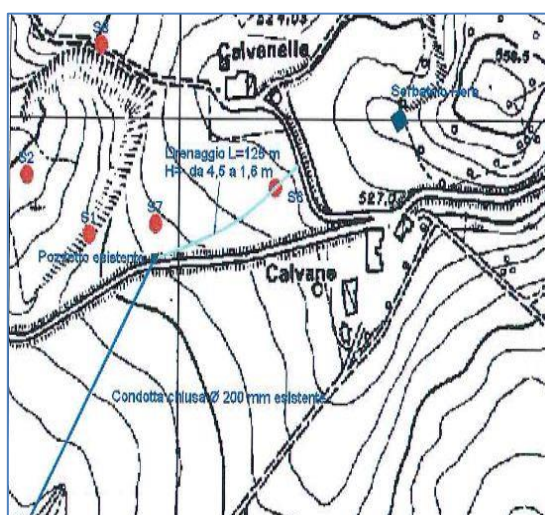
Planimetria progetto esecutivo dell'Ing. D. Manfredini (Feb. 2016).
